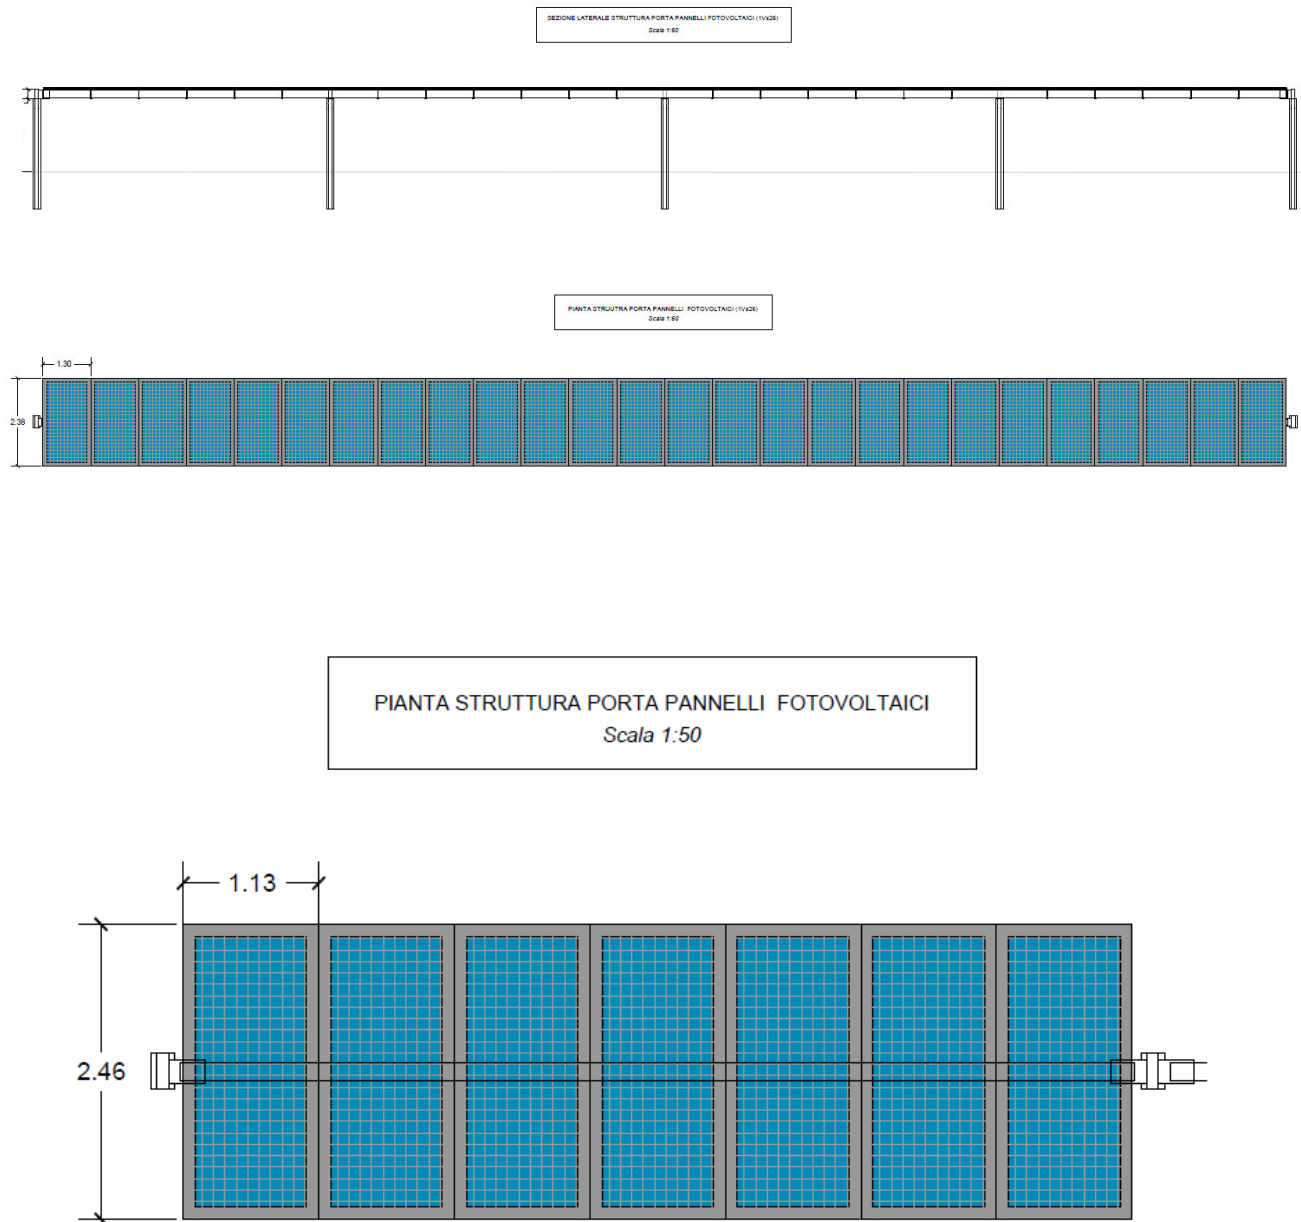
Schema della struttura – vista longitudinale e pianta 1vx26.
